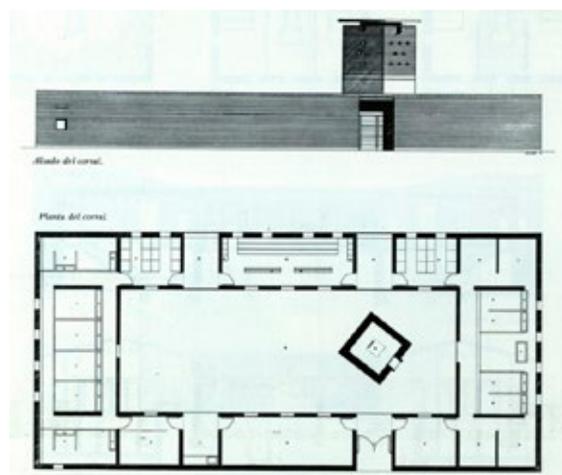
Planta y alzado del corral, Granja Residencia en Villatobas, (Riviere Gómez, 1982).
